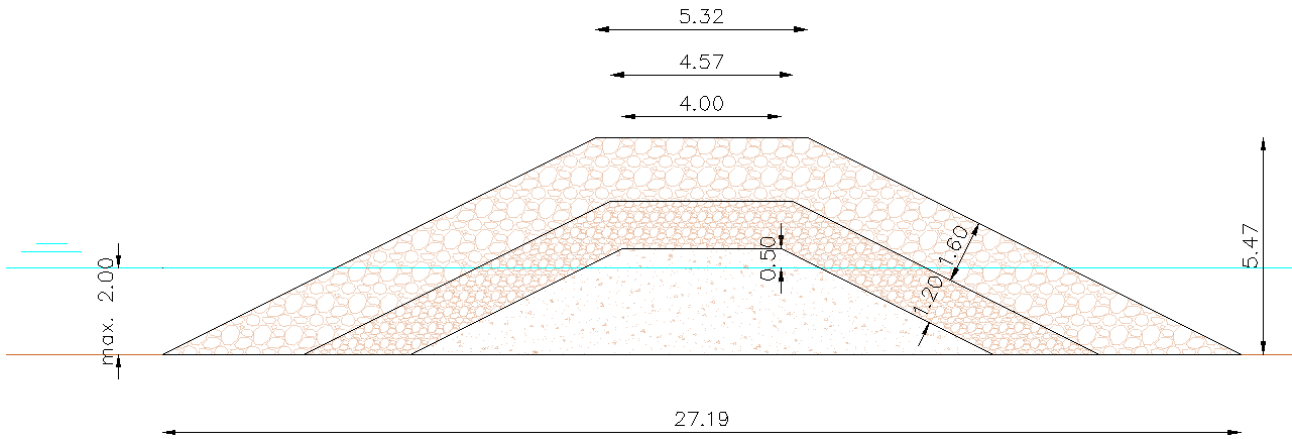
Esquema de la sección principal del espigón. Fuente: Elaboración propia
